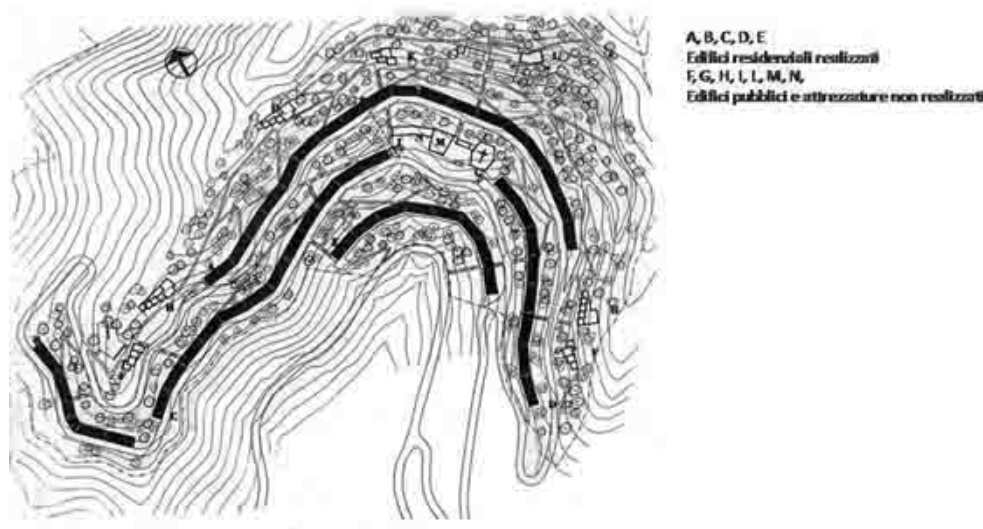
Impianto urbano di progetto del quartiere Forte Quezzi
